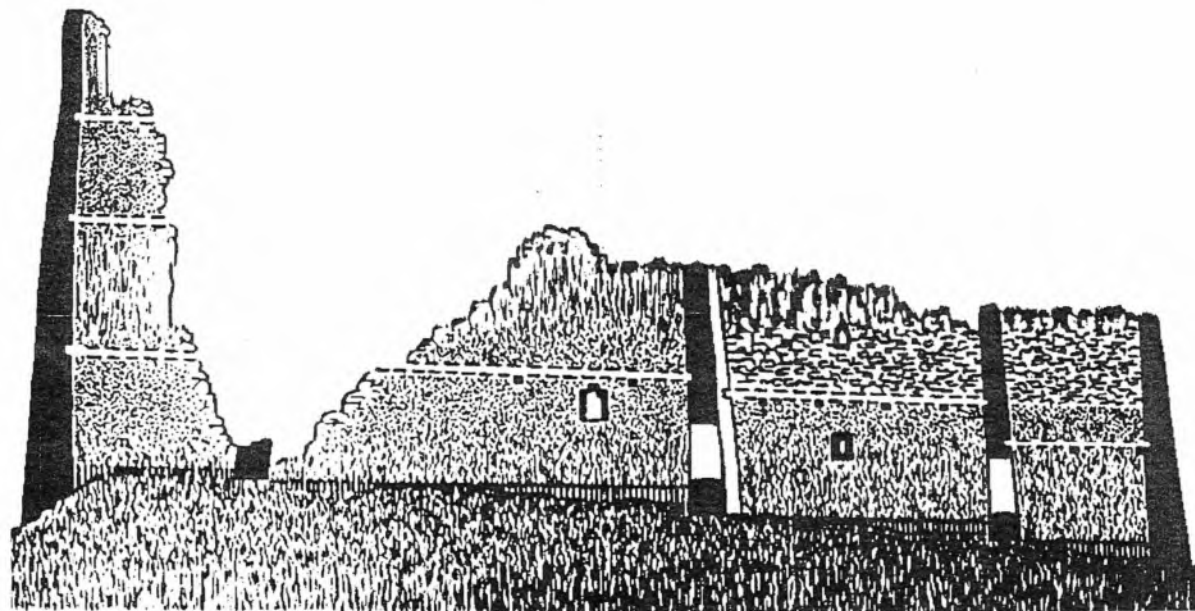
Замок Джабоевых. Разрез. Чертеж В.М.Батчаева
